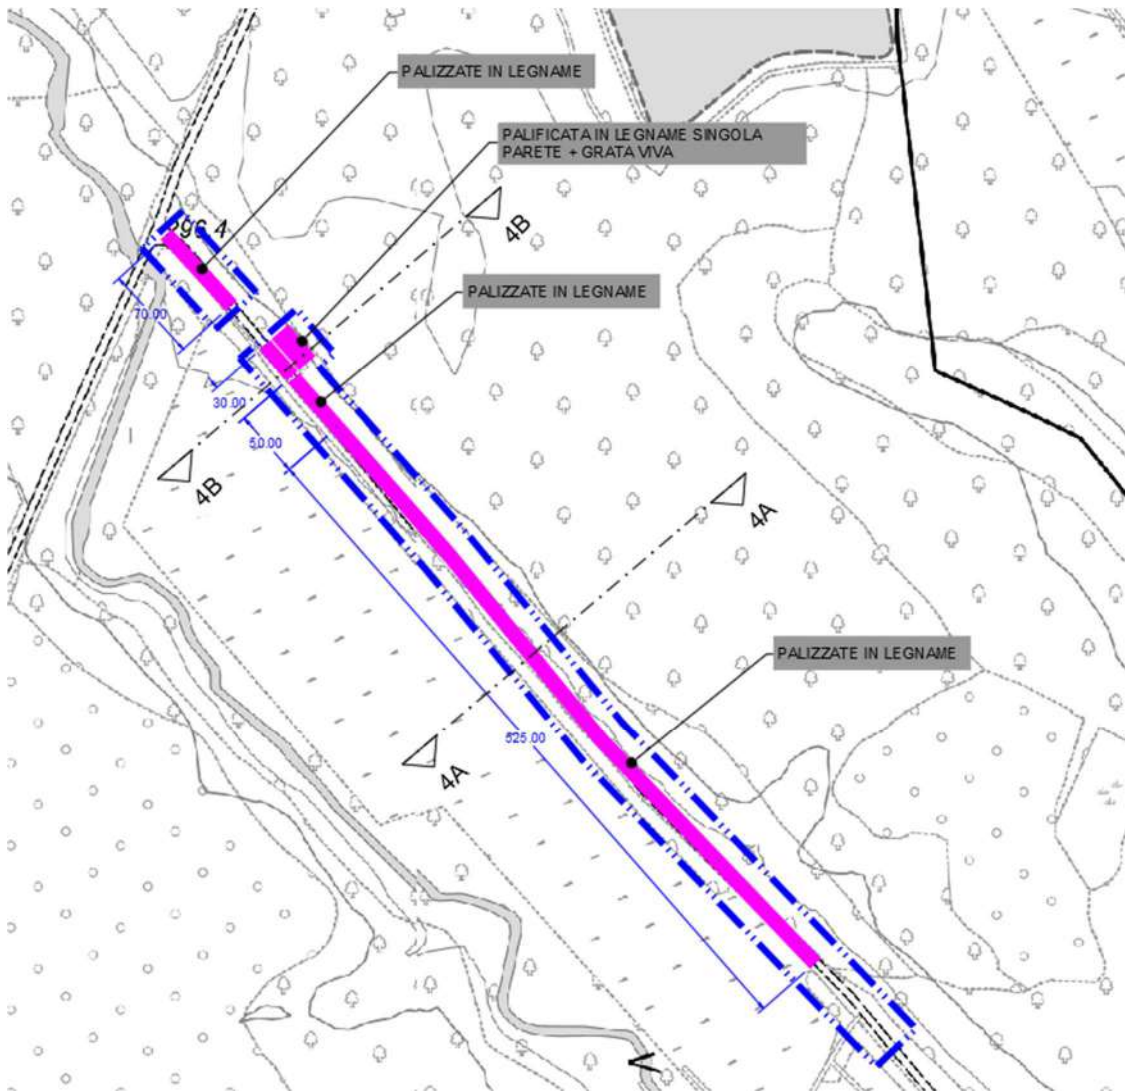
Planimetria di progetto. (rappresentazione non in scala)
